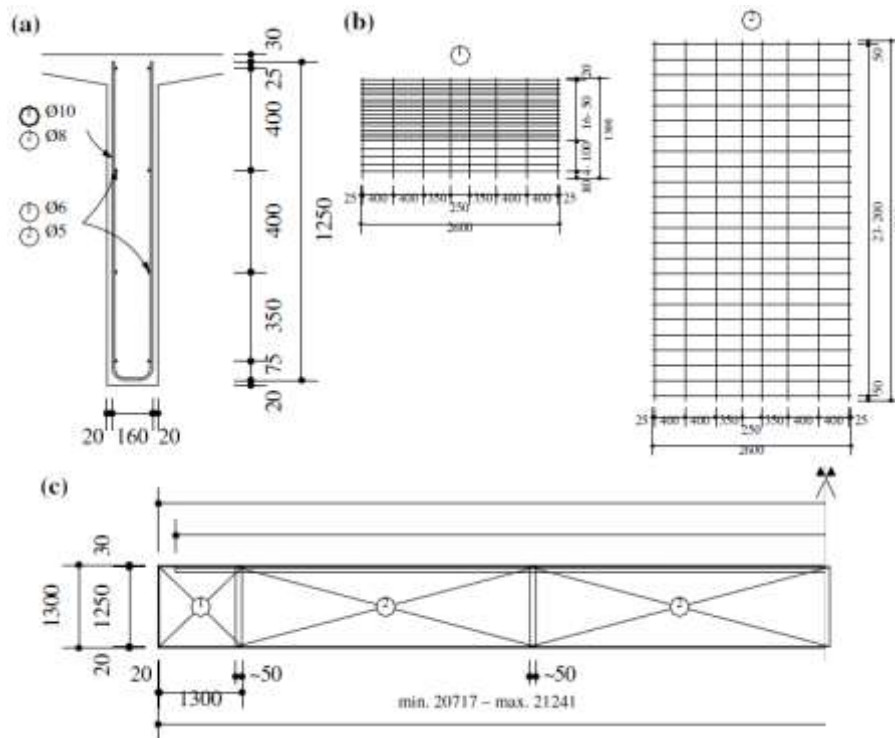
Reforço transversal e longitudinal ordinário das vigas pré-fabricadas do viaduto Wassnerwald (dimensões em mm): (a) Reforço na alma da viga; (b) Geometria da amadura transversal (redes soldadas); (c) Arranjo das armaduras ao longo do comprimento da viga [38].
